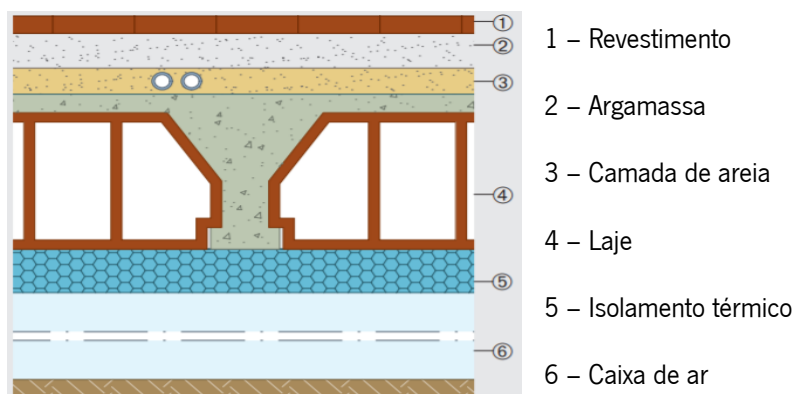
Pormenor construtivo tipo de um pavimento com isolamento térmico na face inferior de laje (DOW, n.d.)
